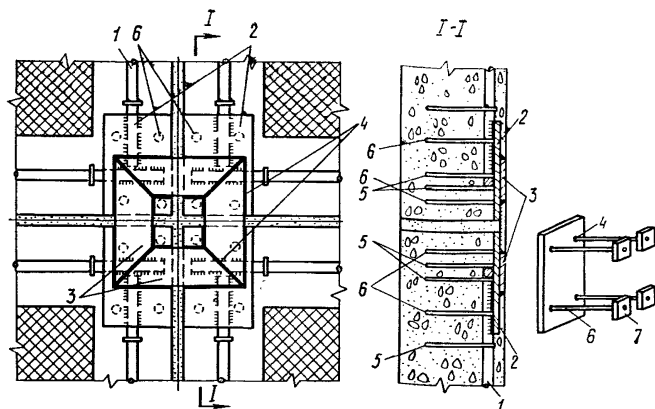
Соединения арматуры в стыках элементов сборных конструкций из жаростойкого бетона
